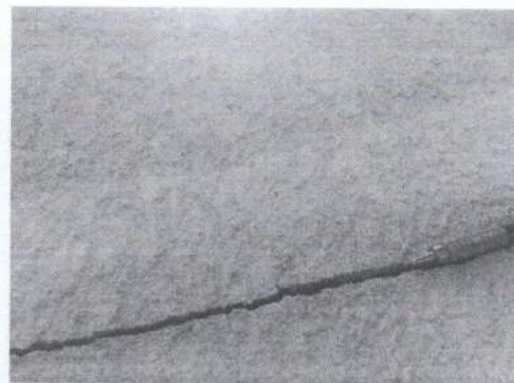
Trinca localizada na fachada – trechos de alvenarias desconectadas
